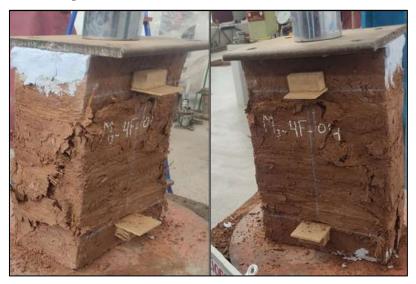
Falla Cónica en Pila muestra M_3 4F 04
